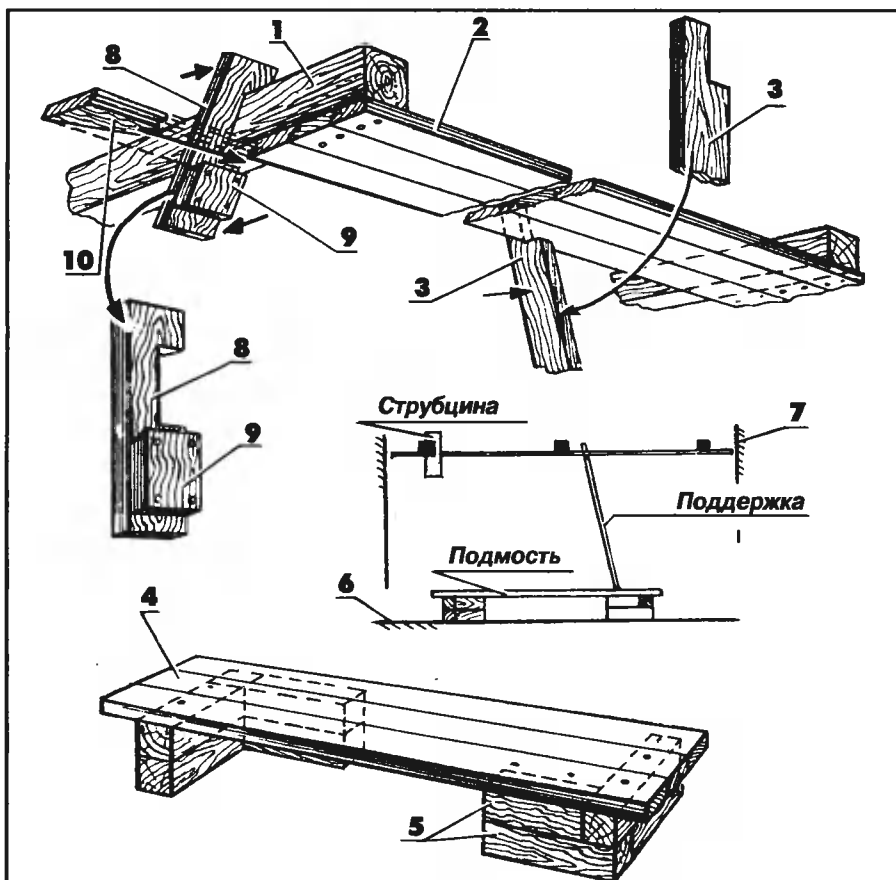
Подшивка потолка: 1 – балка перекрытия; 2 – доска потолочная; 3 – поддержка; 4 – настил; 5 – брус; 6 – плоскость пола; 7 – плоскость стены; 8 – струбцина; 9 – ограничитель; 10 – клин
